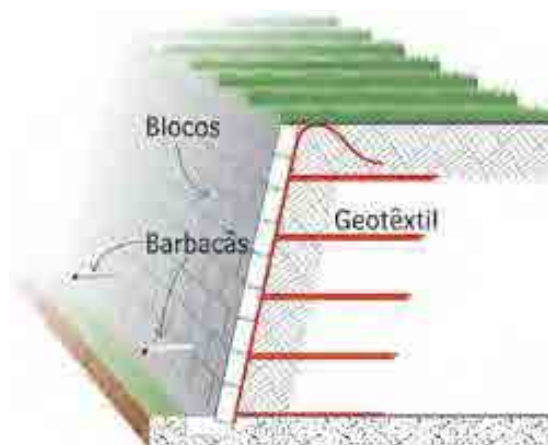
Muro em solo reforçado com face em blocos de concreto (Leal, 2011).
